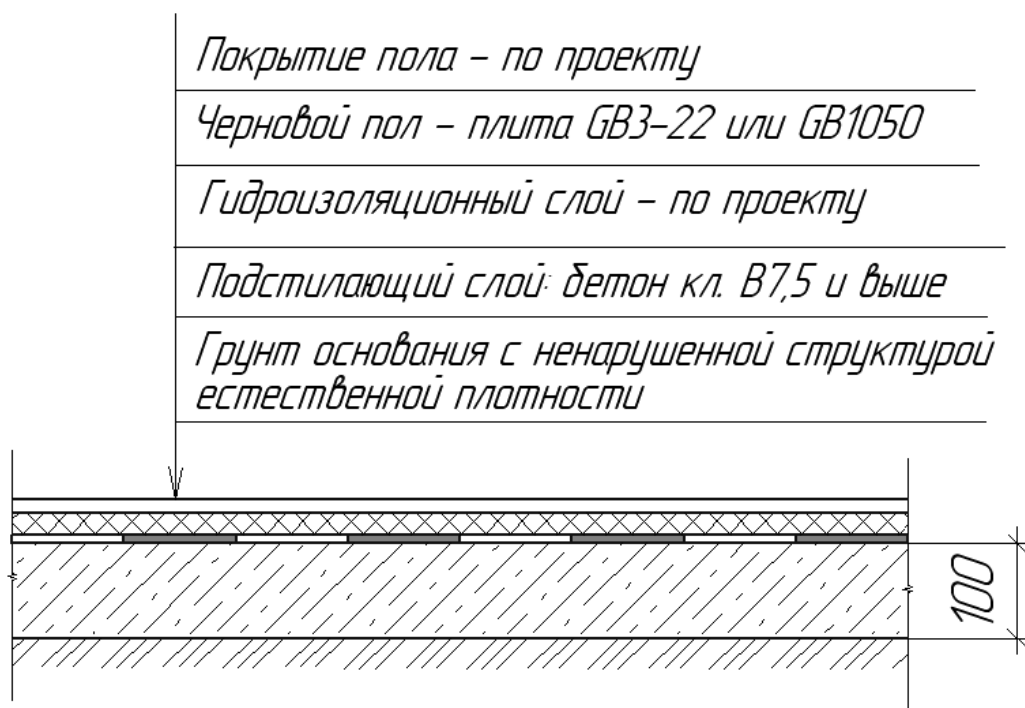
Конструкция монолитного пола по грунту с применением системы плит GREEN BOARD® без утепления, с подстилающим бетонным слоем, без выравнивающей стяжки
